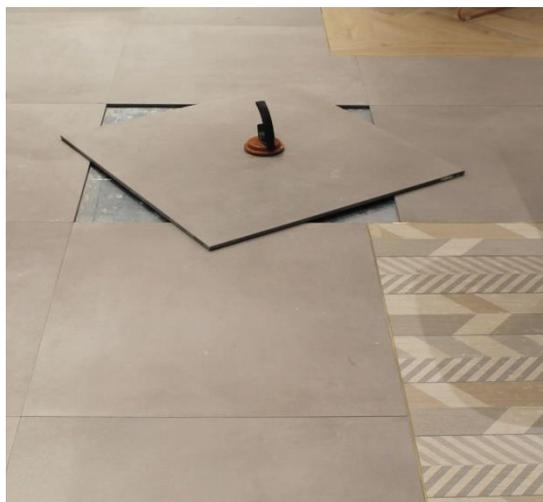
Pavimentazione sopraelevate finitura in gres effetto cemento
